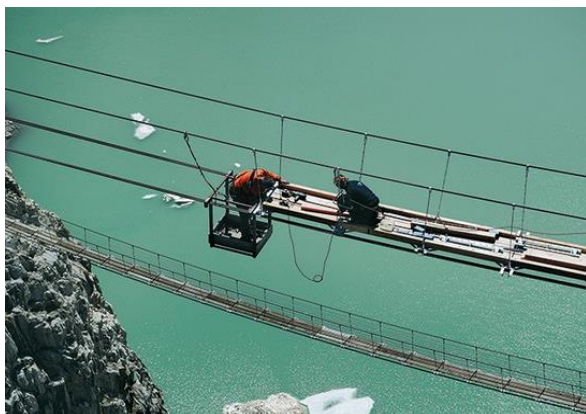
Colocação das travessas e respetivo pavimento, extraído de <http://www.detail-online.com>.
